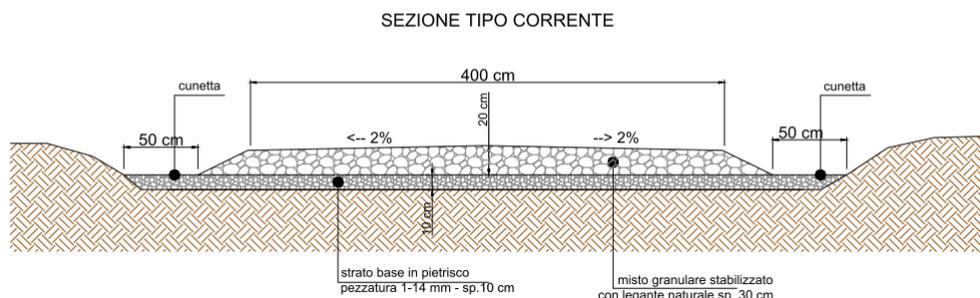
Sezione tipo strada principale di accesso (estratto di PRO\_TAV\_15a)
